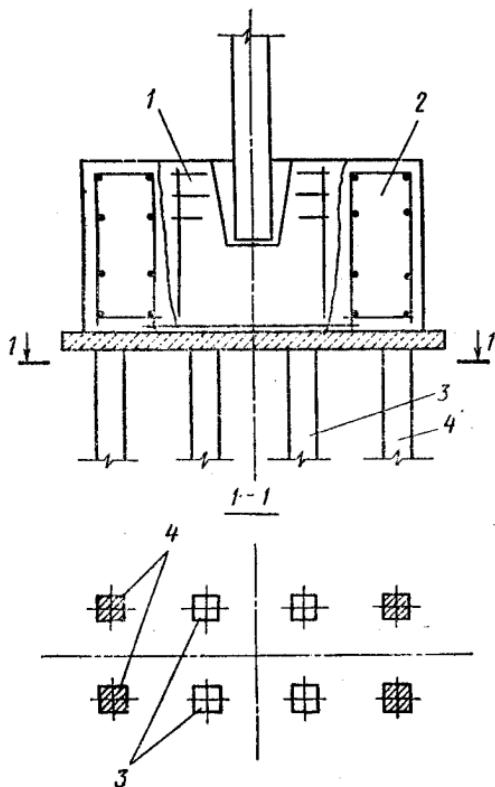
Усиление фундамента ростверком, расположенным в пределах высоты фундамента:
